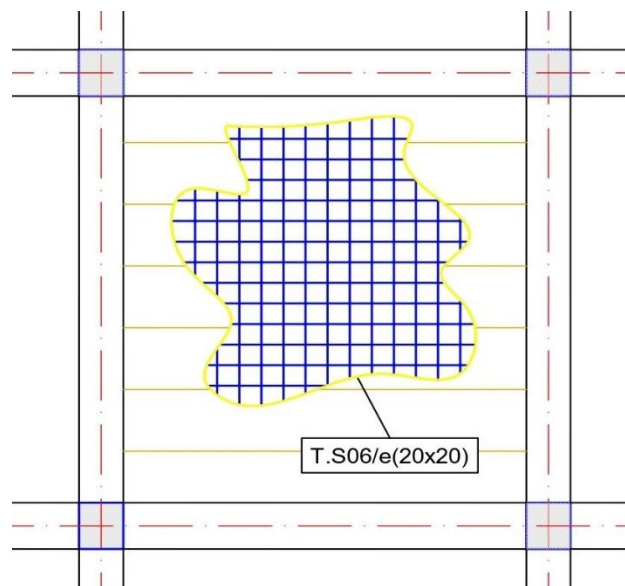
Schéma de ferrailage de la dalle de compression
